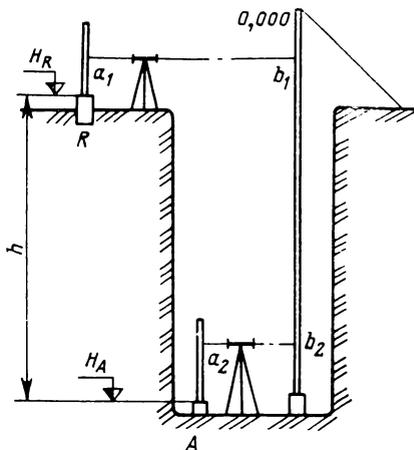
Схема передачи отметки на дно котлована с вертикальными стенками или траншеями
